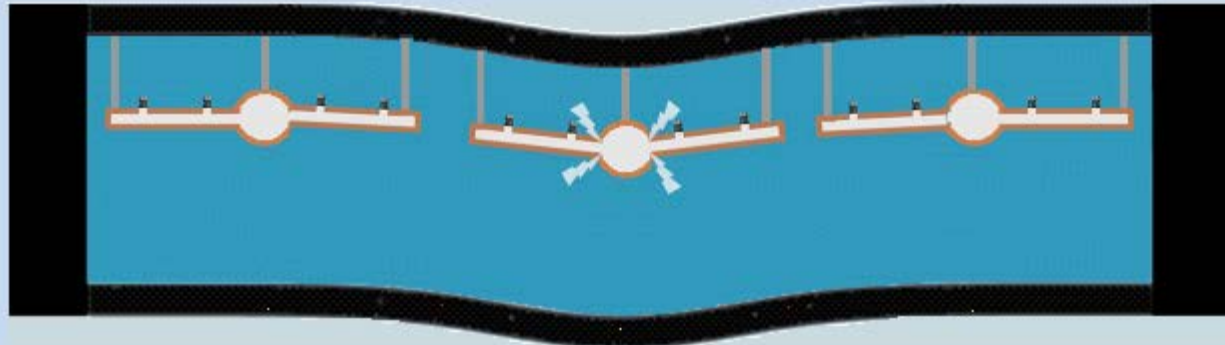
Продолжение начального разрушения герметичности стыков трубопроводов при резонансных колебаниях. Положение жёстко подвешенных распределительных  и питающих  трубопроводов при отклонении упругой конструкции из плит подвала вниз от положения устойчивого равновесия. -спринклер. -подвеска. -утечка воздуха.
